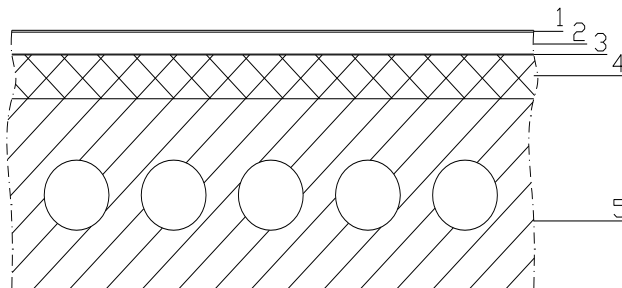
Конструкція стелі (міжповерхове перекриття)
